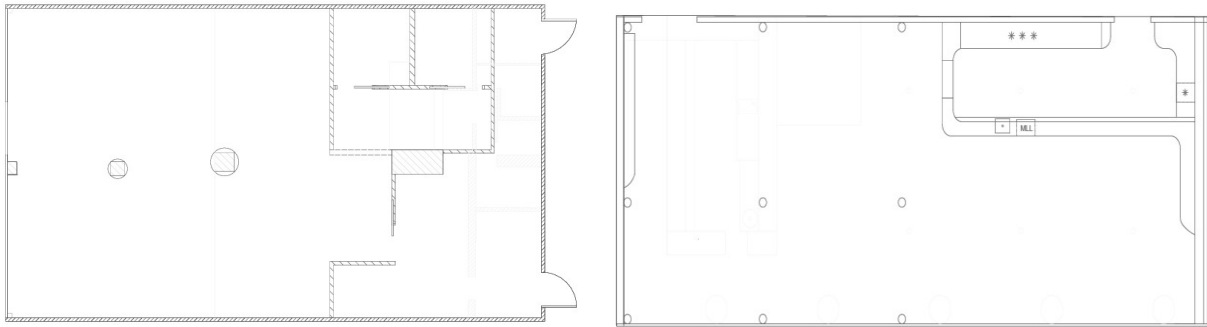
Plantas de alterações Deck e Bar Interno (Camila,2025)
